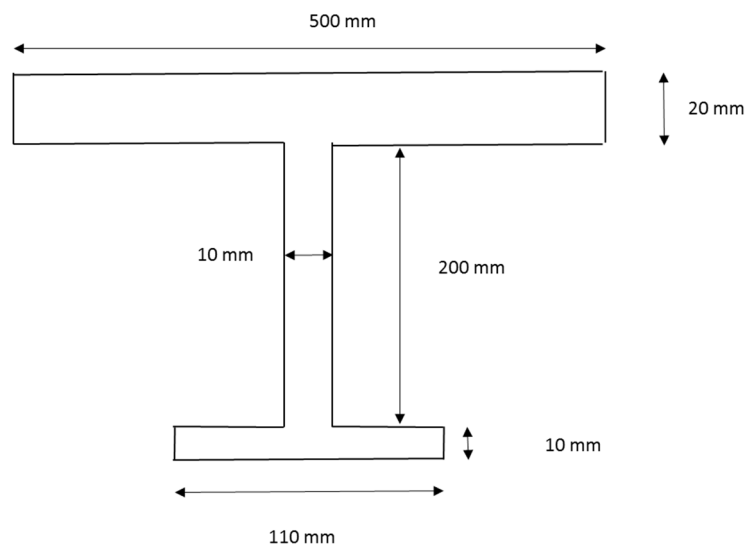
Plan de la section du tablier tout aluminium de l'exemple 1
